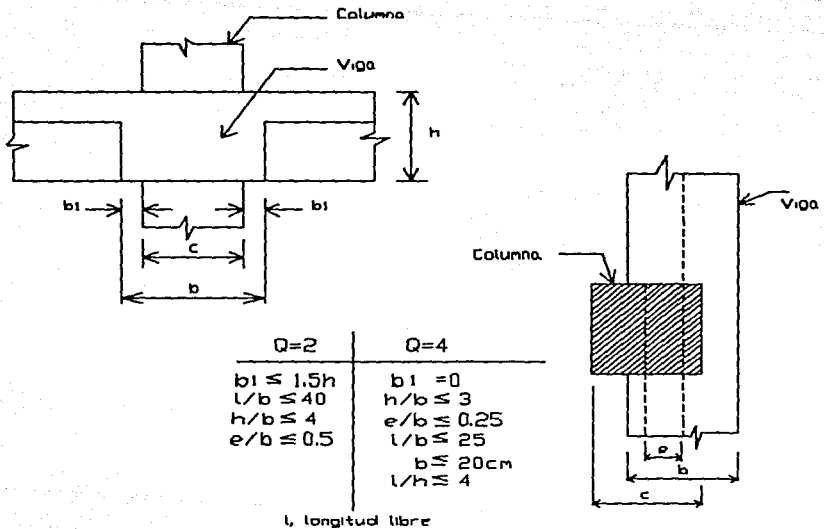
Requisitos geométricos para vigas de concreto reforzado. (1.6)
